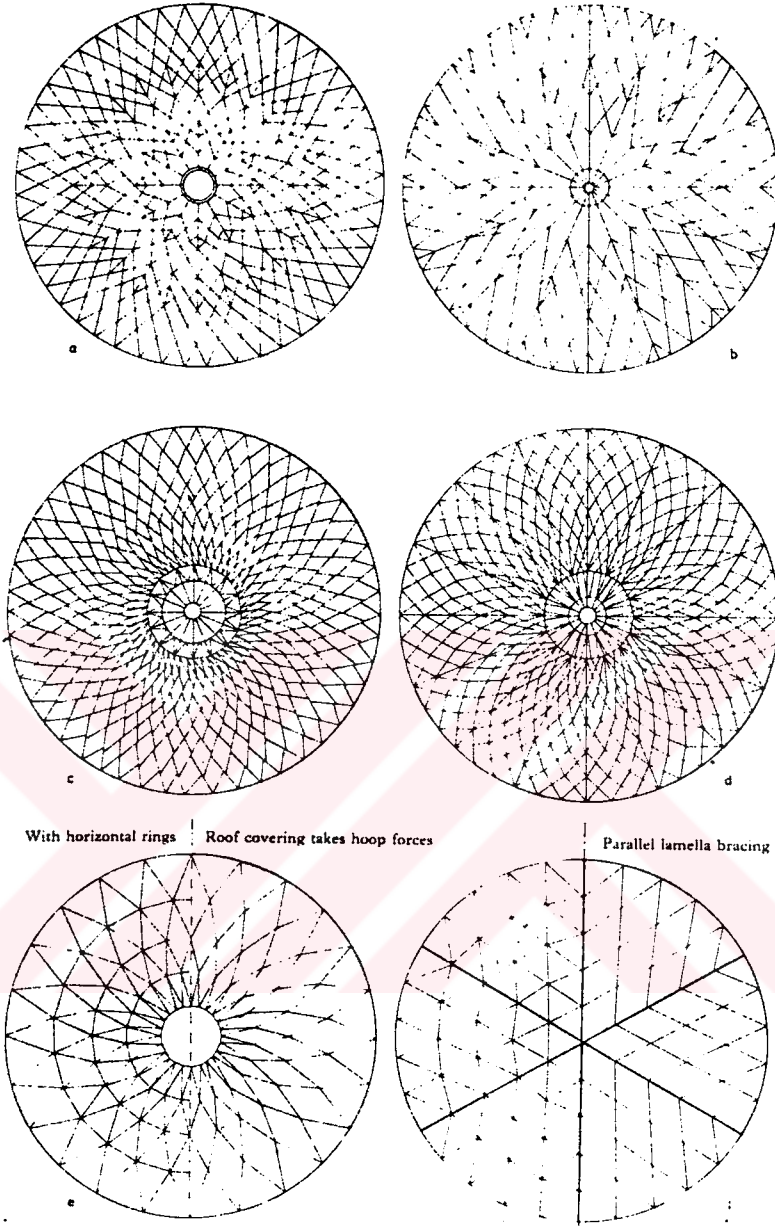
Schlink Kubbelerin plan ve görünüşleri
